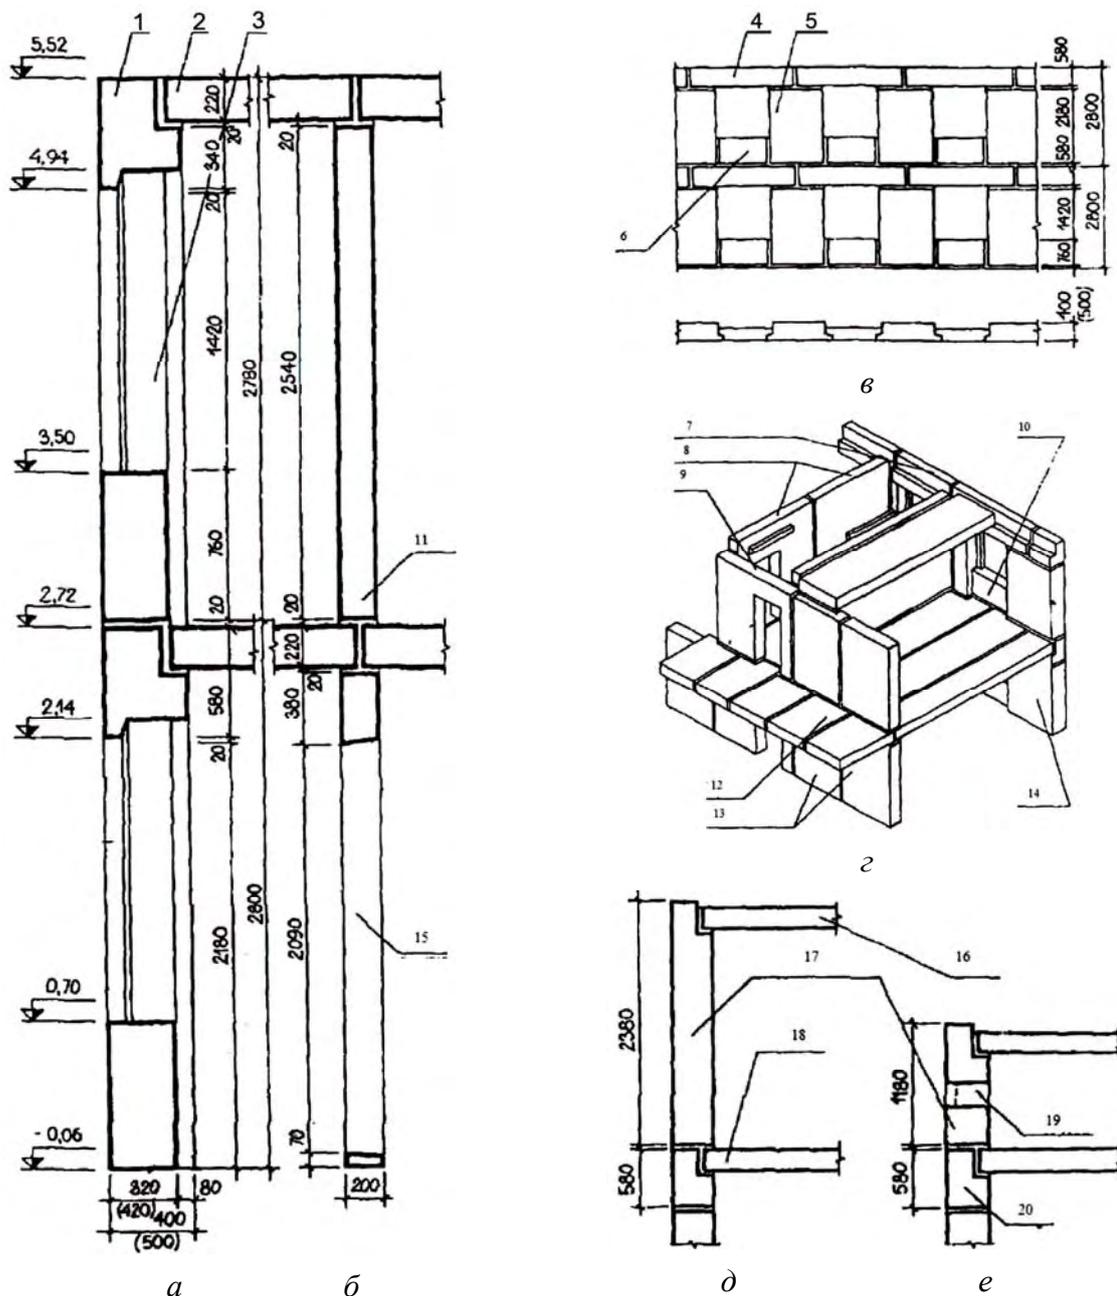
Детали стен из крупных легкобетонных блоков: *a* — порядовка наружной стены; *б* — порядовка внутренней стены; *в* — разрезка наружной стены; *г* — конструктивная схема фрагмента крупноблочного здания; *д* — парапет в здании с чердаком; *е* — парапет в здании без чердака: 1 — перемычный блок; 2, 12, 18 — панель перекрытия; 3, 14 — простеночный блок; 4, 7, 20 — перемычный блок; 5, 14 — простеночный блок; 6, 10 — подоконный блок; 8 — блоки лестничной клетки; 9 — электроблок; 11 — блок внутренней стены; 13 — блоки внутренней стены; 15 — блок внутренней стены с дверью; 16 — панель покрытия; 17 — парапетный блок; 19 — продух
